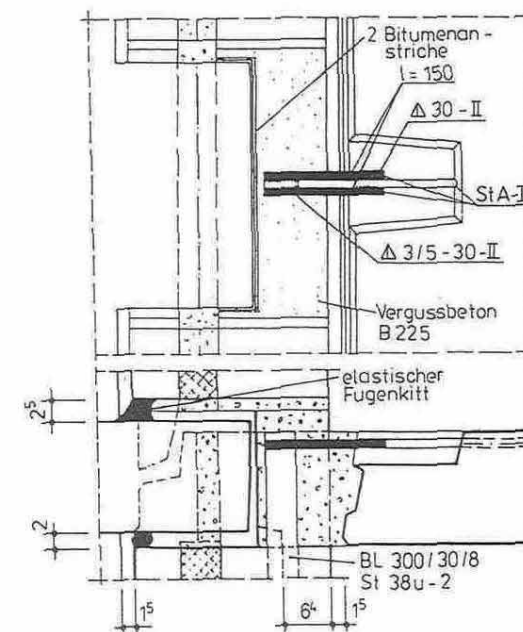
PH 12 Frankfurt/O. - Verbindung Außenwand - Loggiadecke - Decke Dübelverbindung
